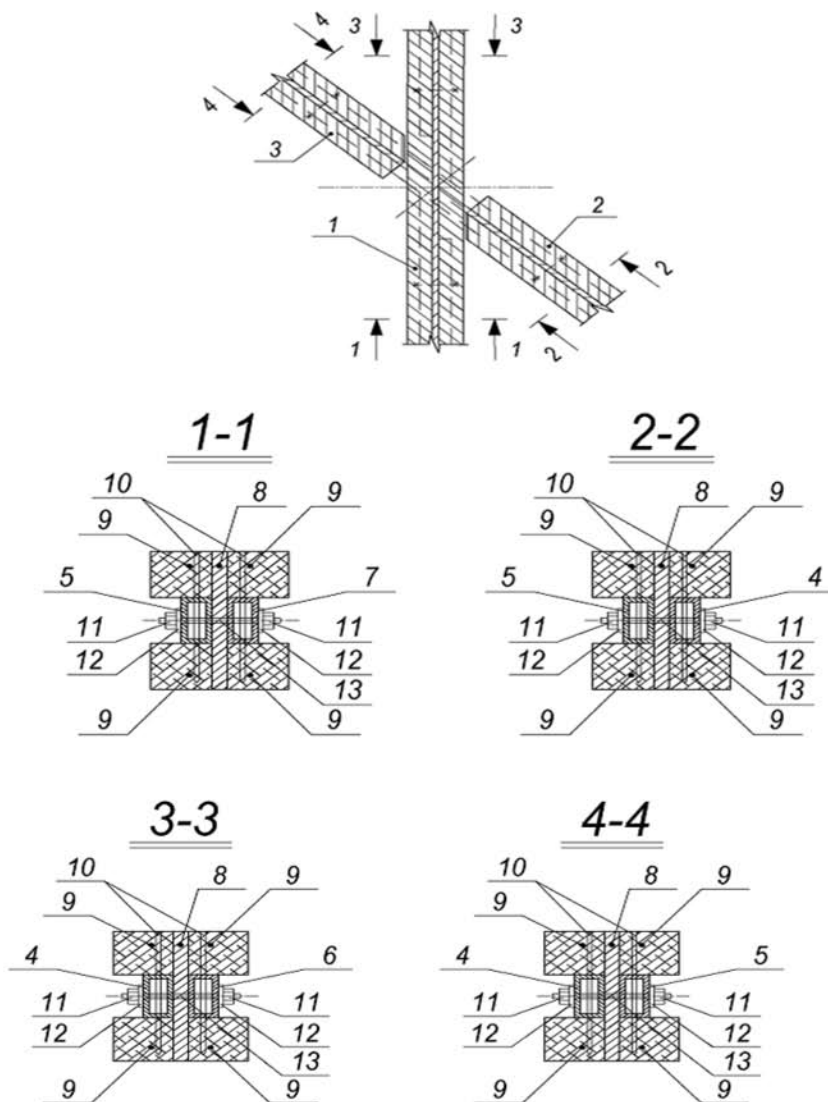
Перекрестный узел двутавровых деревянных балок комбинированных элементов-оболочек
